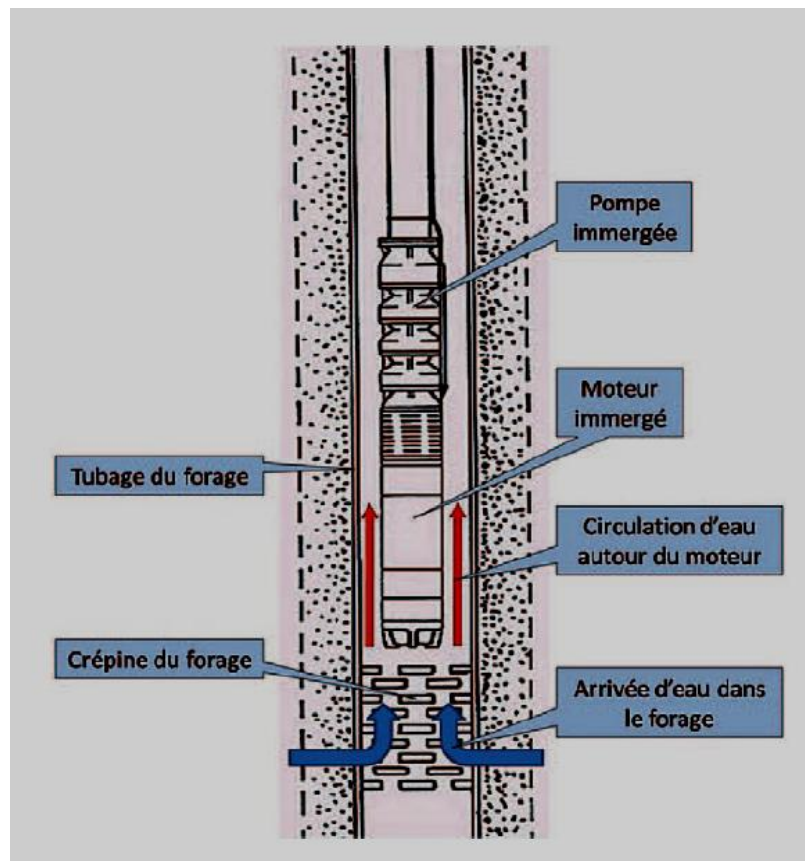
Règles d'installation d'un groupe immergé dans un puits de forage
